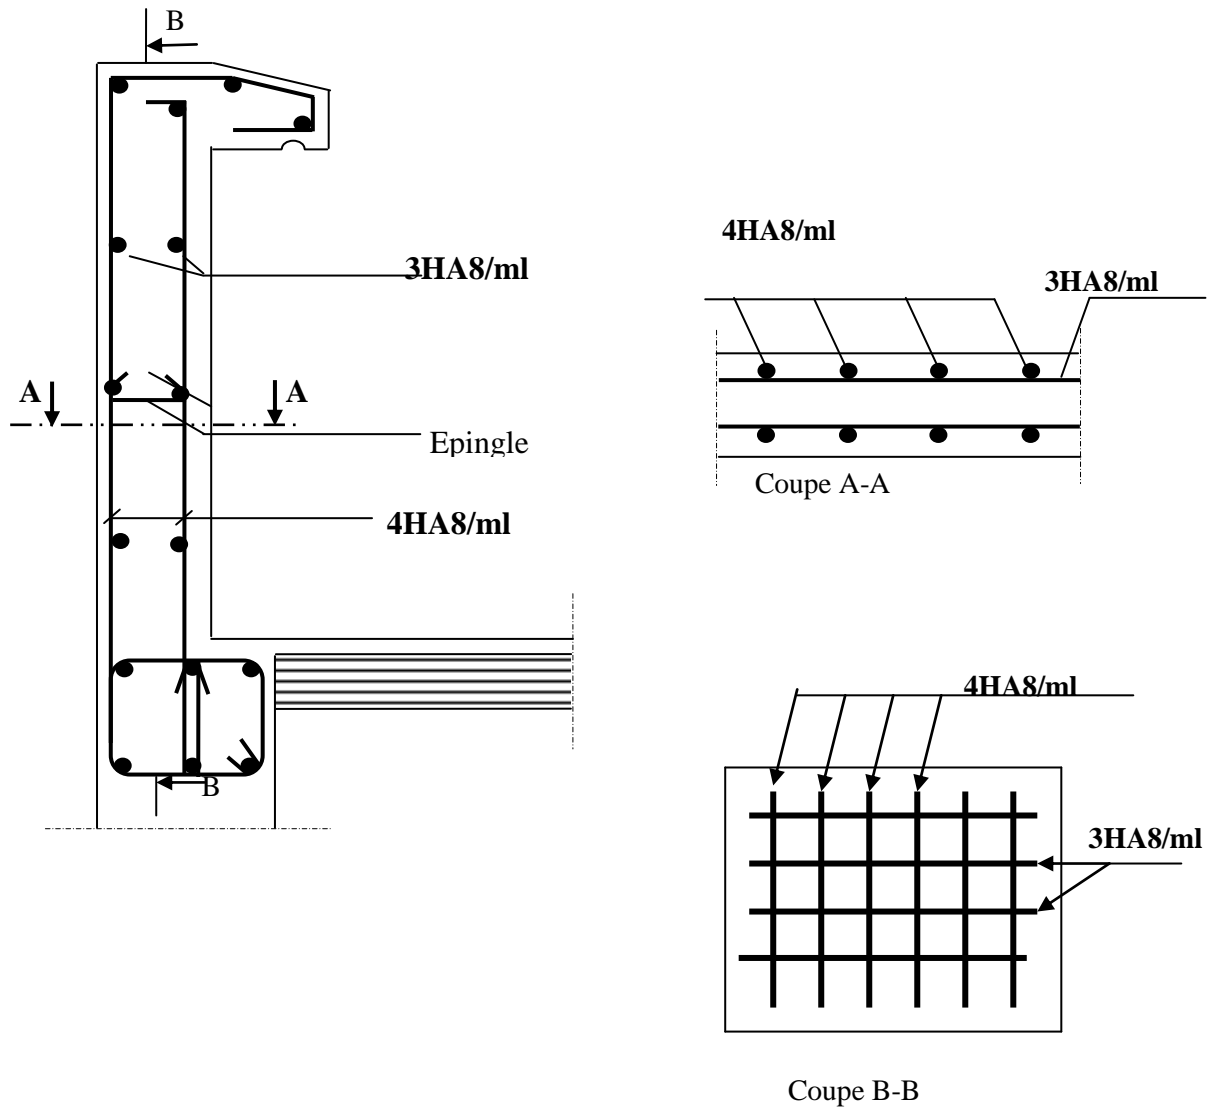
Plan de Ferrailage de l'acrotère.
